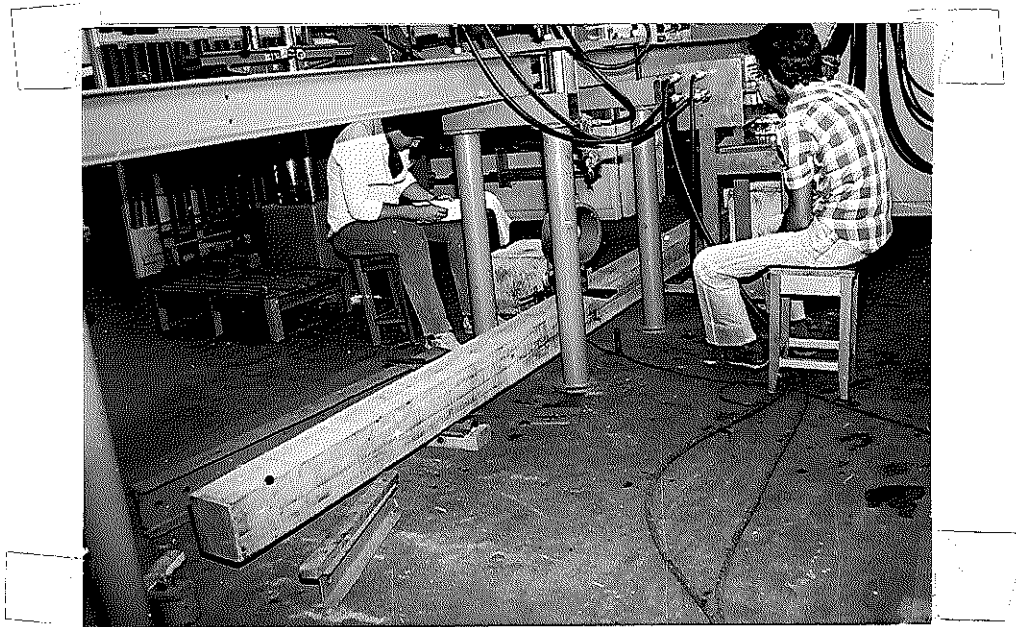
Vista Geral da Montagem do Ensaio Preliminar
